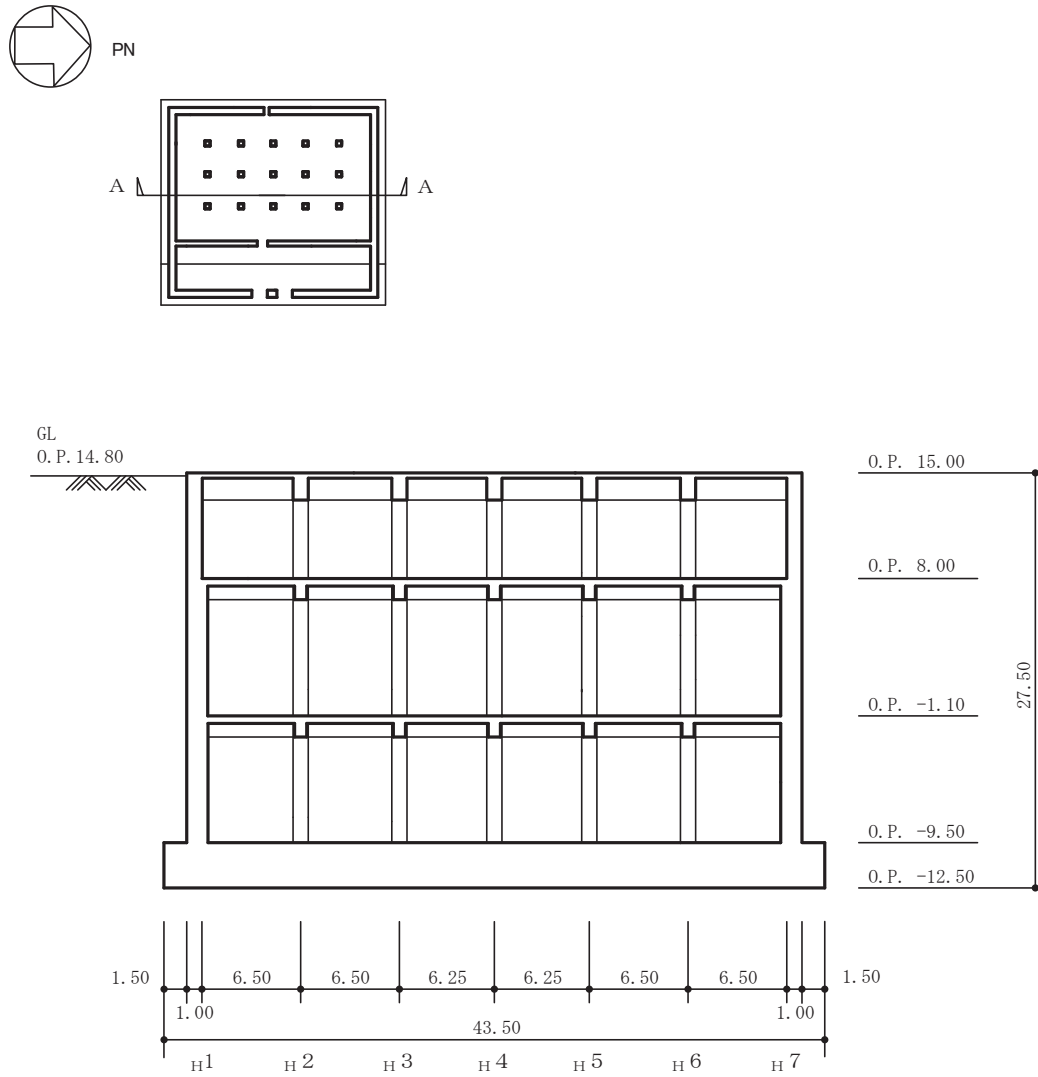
(2) 第 3 号機海水熱交換器建屋の概略平面図 (O.P. -1.1m)
